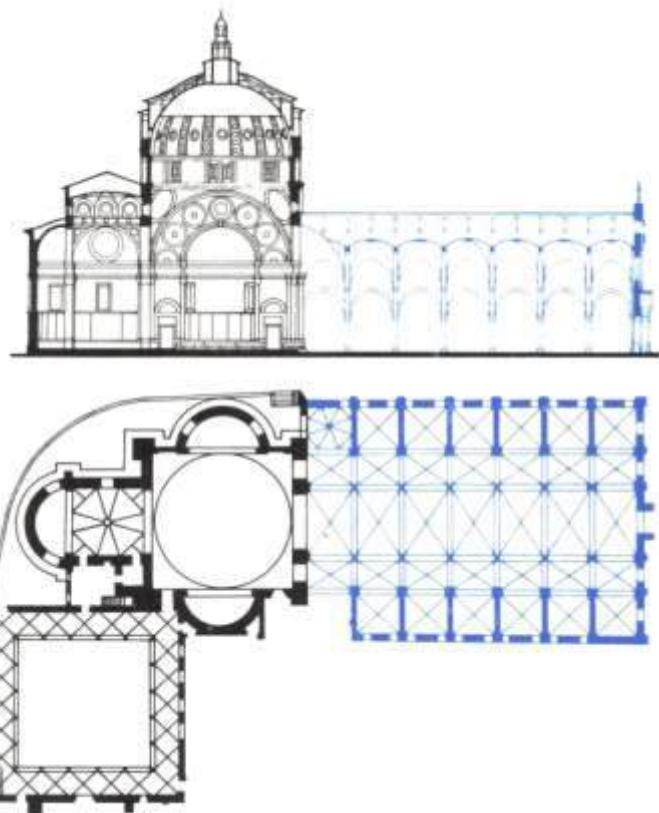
Santa Maria delle Grazie, alzado y planta.
